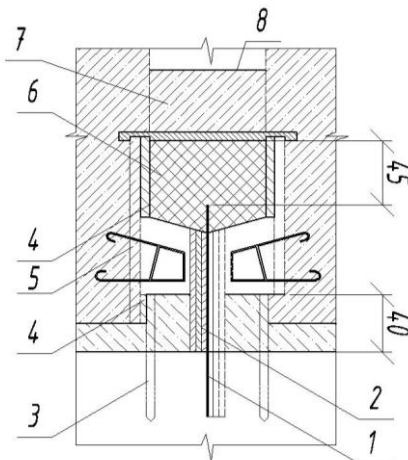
З'єднання шпунта з фундаментною плитою за допомогою шпонки
